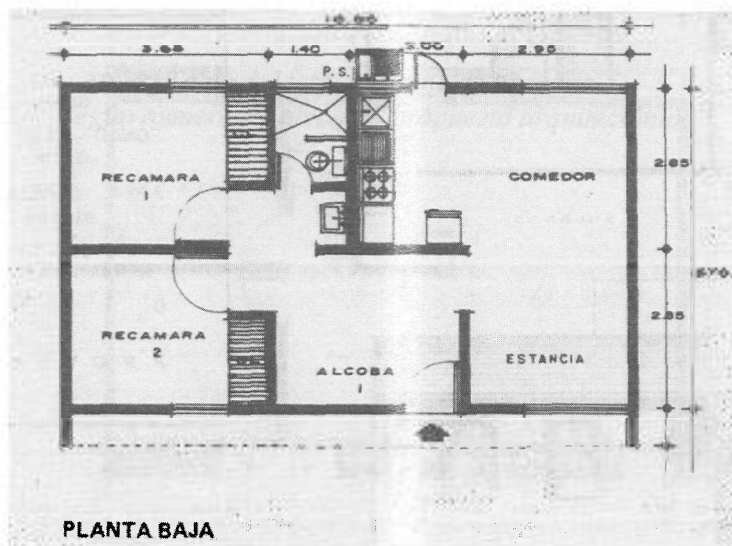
Propuesta arquitectónica tipo 2[1]
